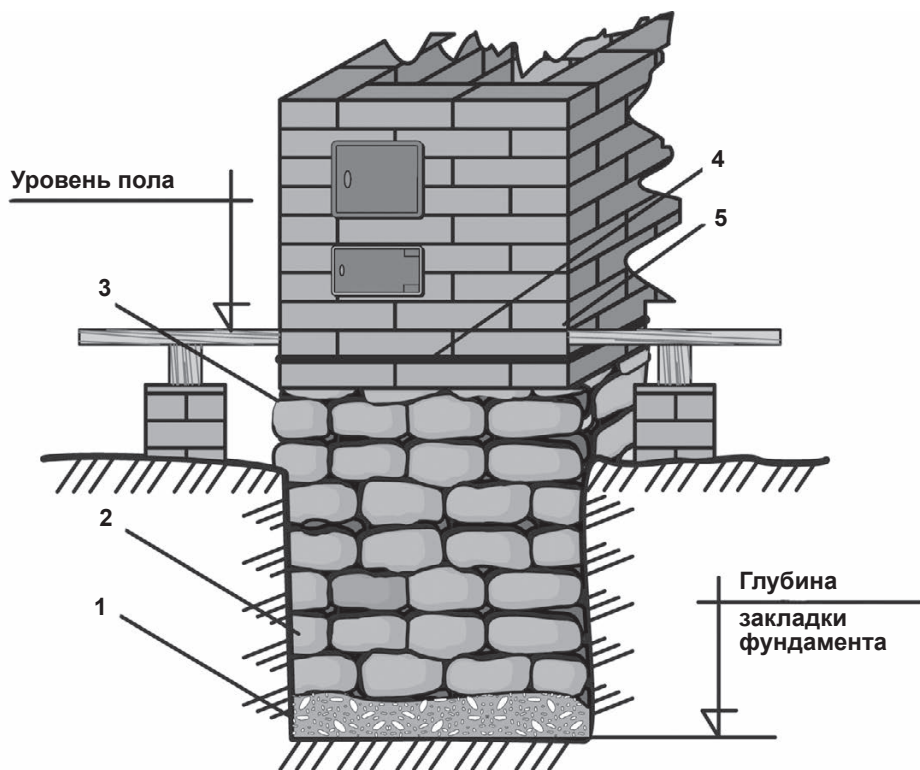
Устройство фундамента под печь: 1 — подошва; 2 — подземная часть; 3 — верхний срез; 4 — гидроизоляция; 5 — печная кладка
